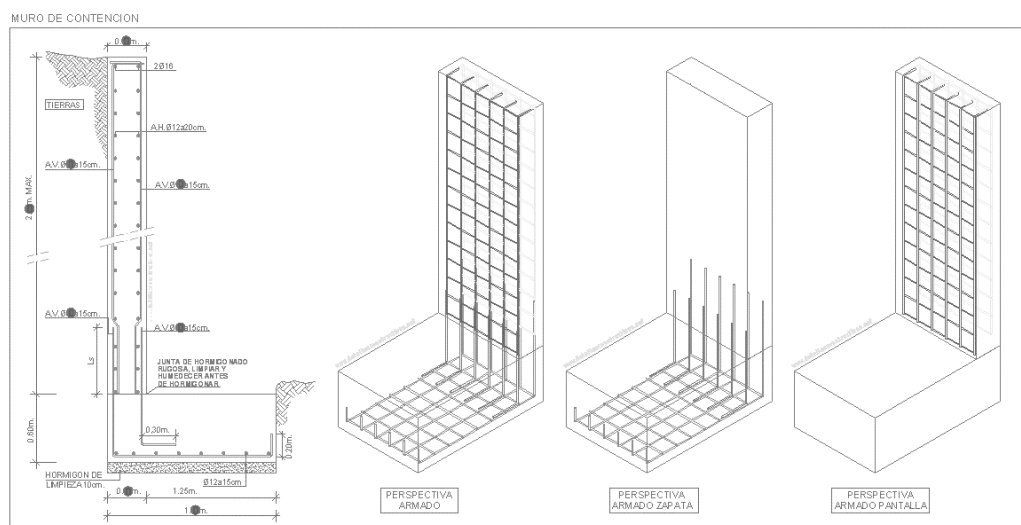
Esquema conceptual del sistema constructivo del concreto armado.
